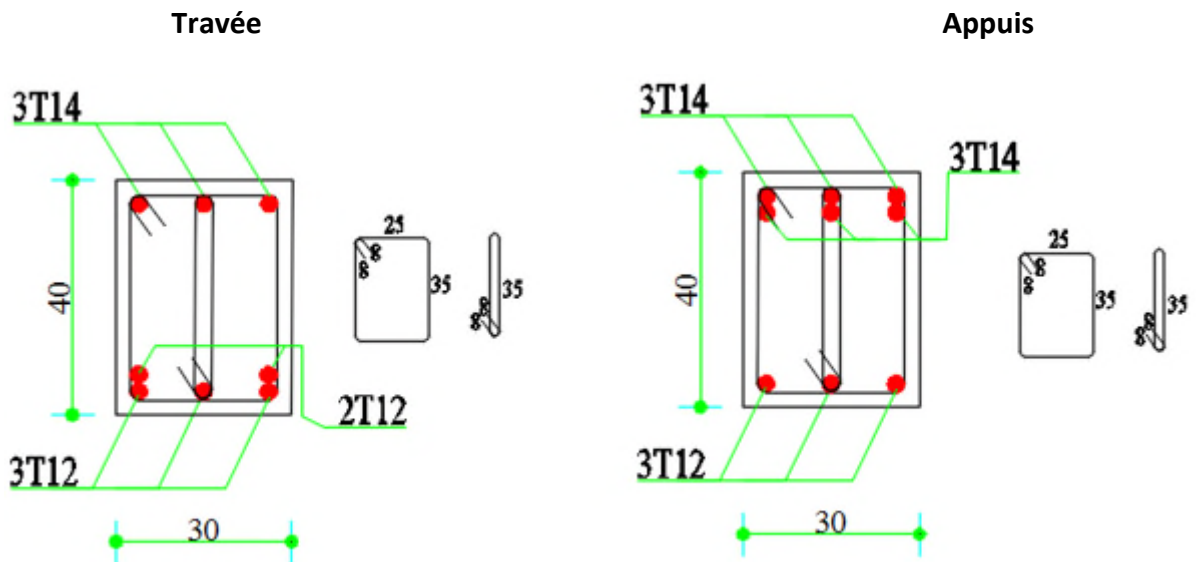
Schéma de ferrailage de la poutre secondaires des étages courants
